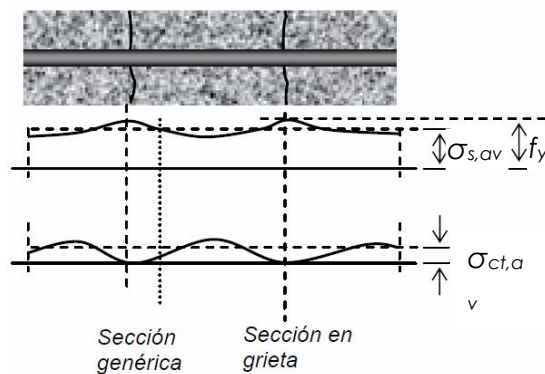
Barra sometida a tracción. El acero ha alcanzado la tensión de cedencia  $f_y$  en grieta.
